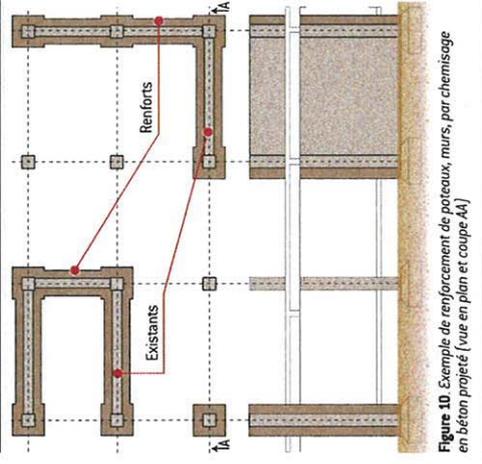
Exemple de renforcement de poteaux, murs, par chemisage en béton projeté (vue en plan et coupe AA)
